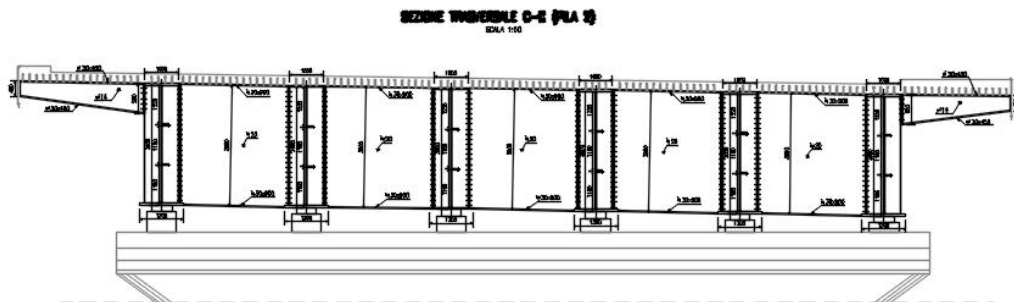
Struttura impalcato - Sezione trasversale pila P2
